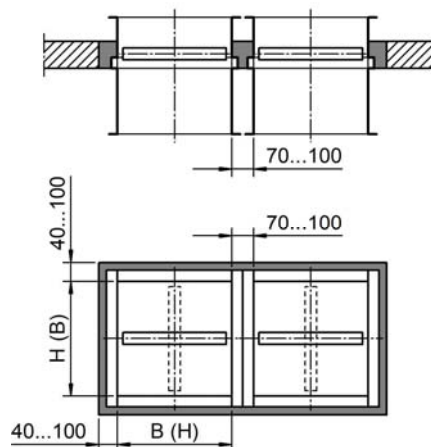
ringopeningsafmetingen volledige uitmorteling in massieve plafonds
